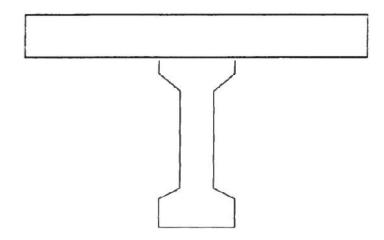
Poutre en I de section constante sur toute sa longueur
